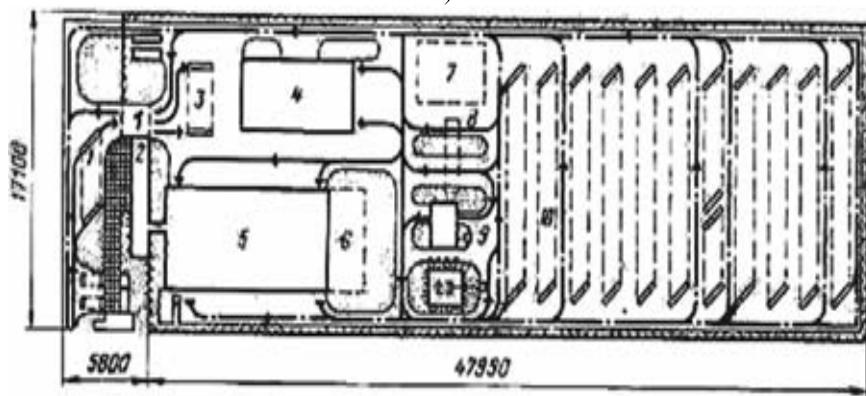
Генеральный план АТП на 300 грузовых автомобилей:
